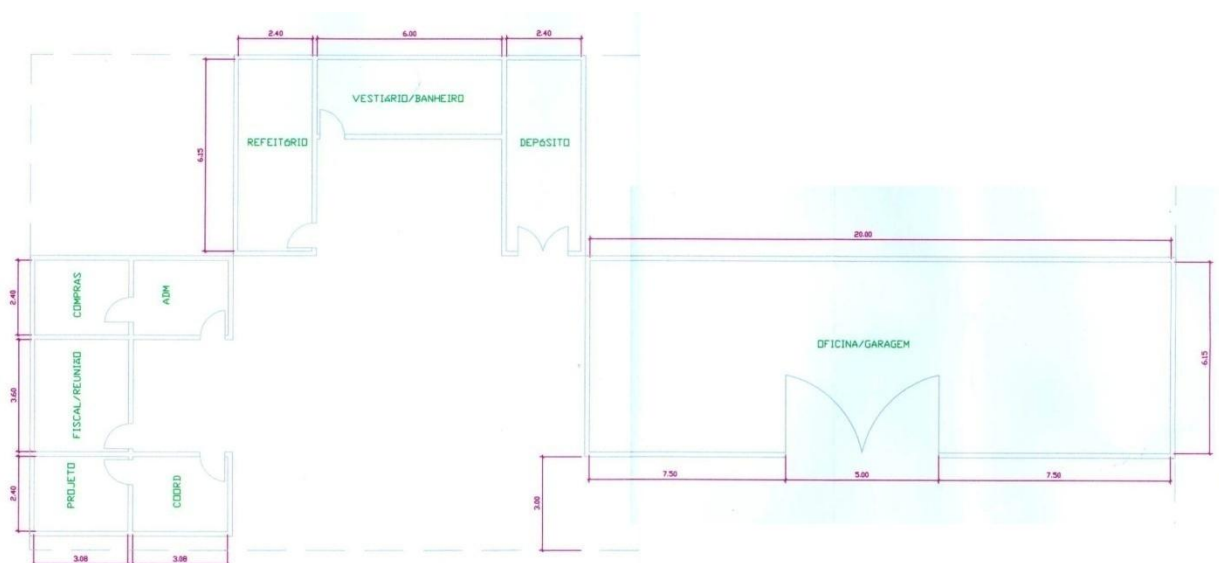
A Layout do Canteiro de Obras e Acampamento
